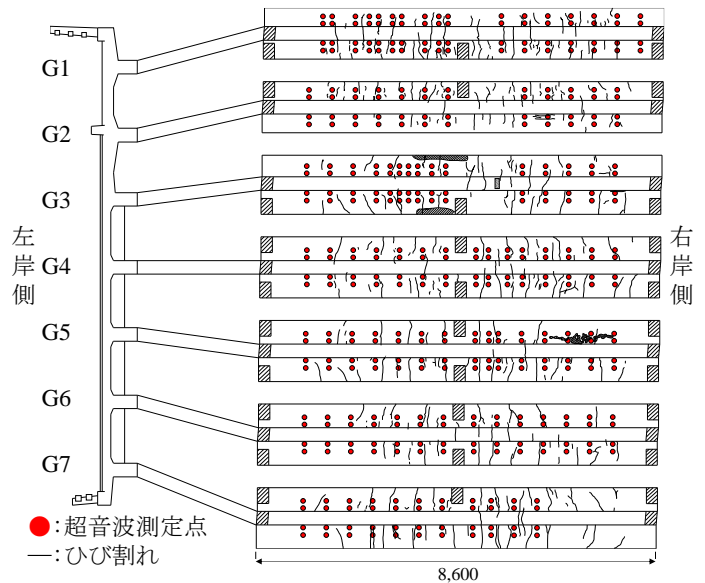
主桁のひび割れ展開図と超音波測定点
